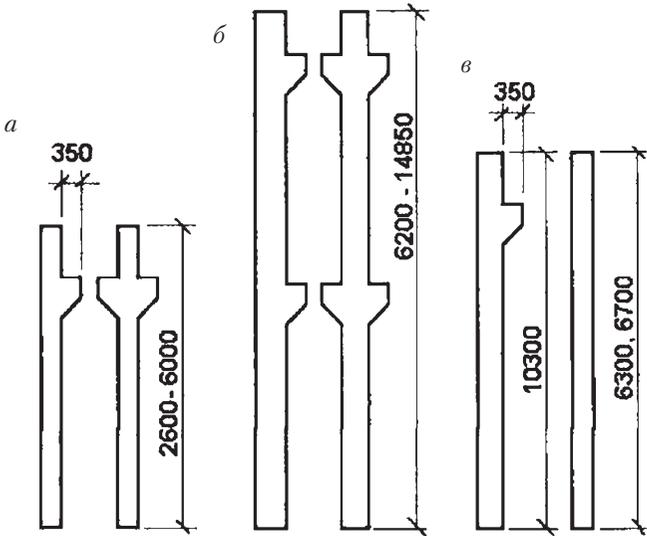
Унифицированные железобетонные колонны: а – для верхних и средних этажей; б – для верхних, средних и нижних этажей (без указания величины заделки в фундаменте); в – для верхних крановых этажей
